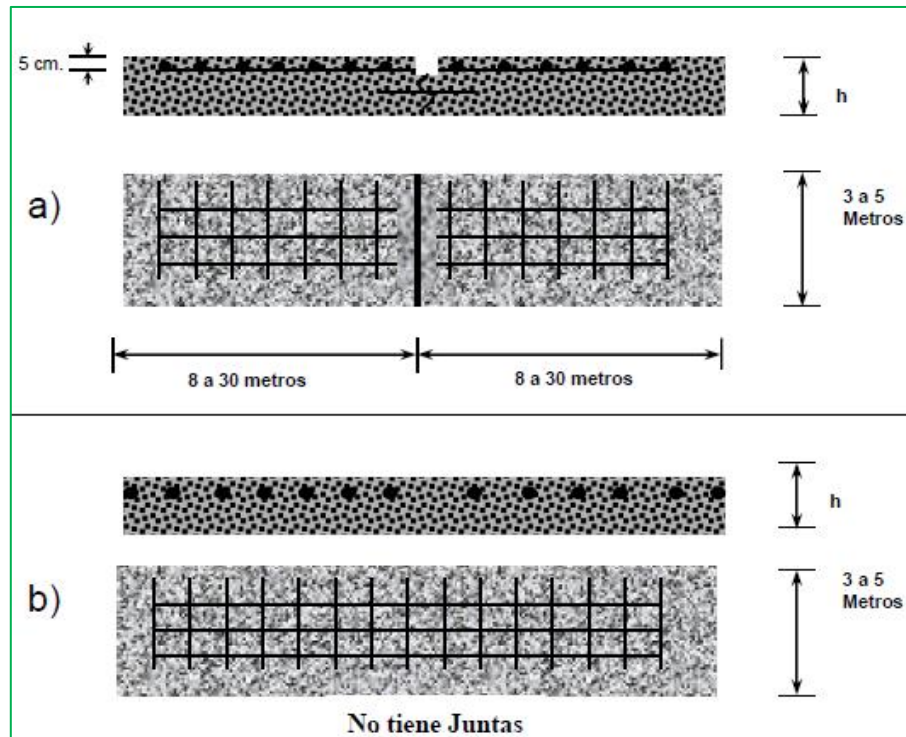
a) Pavimento con refuerzo discontinuo distribuido no estructural. b) Pavimento con refuerzo continuo sin función estructural. (Ref. Bibliografía 8)
